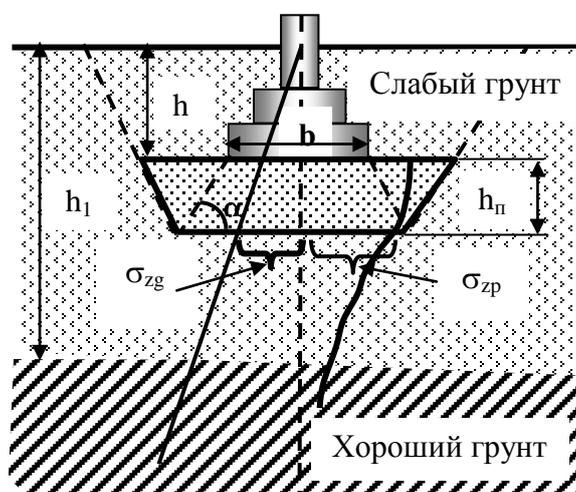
Расчетная схема к определению размеров песчаной подушки
